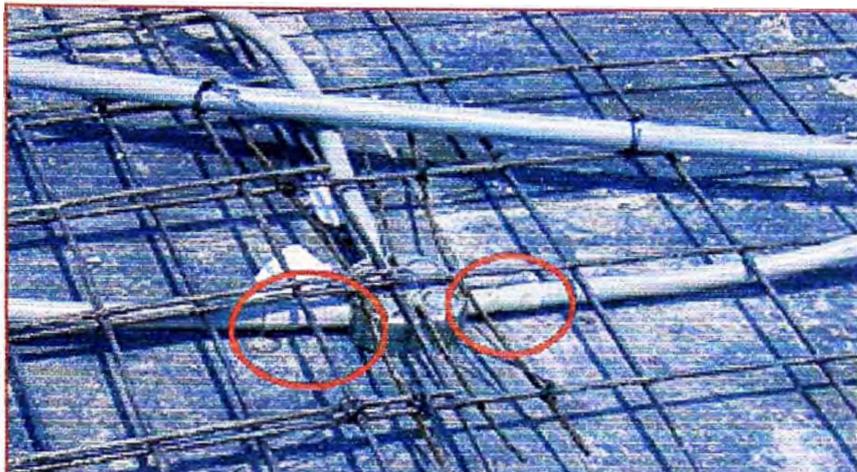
Poco recubrimiento entre tubería y fondo de Losa
